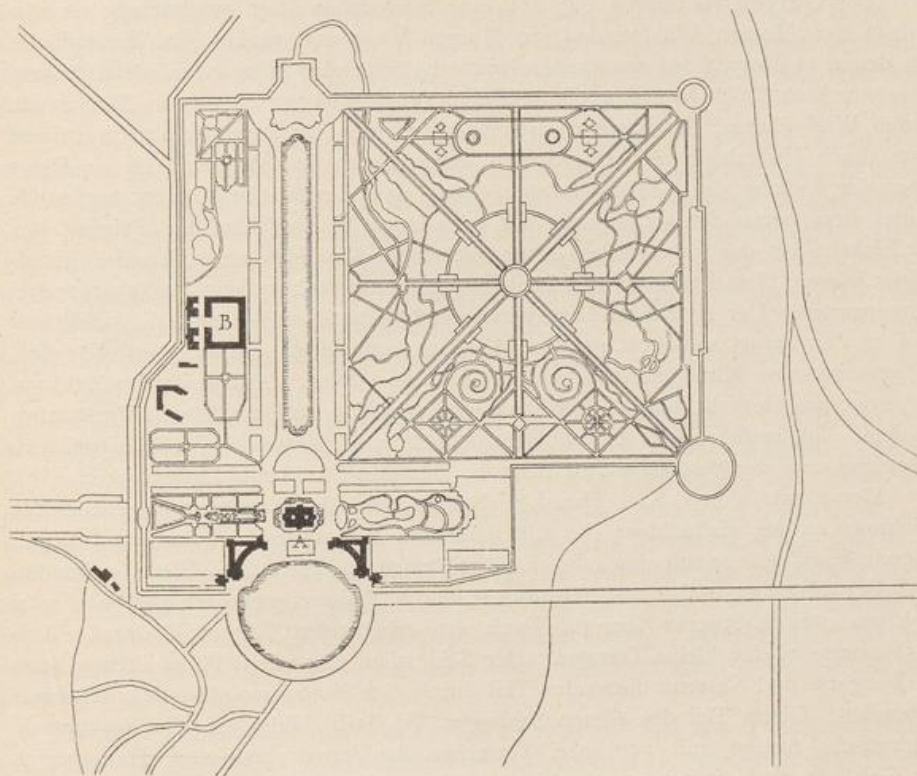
Benrath. Grundriss der Gartenanlage.
